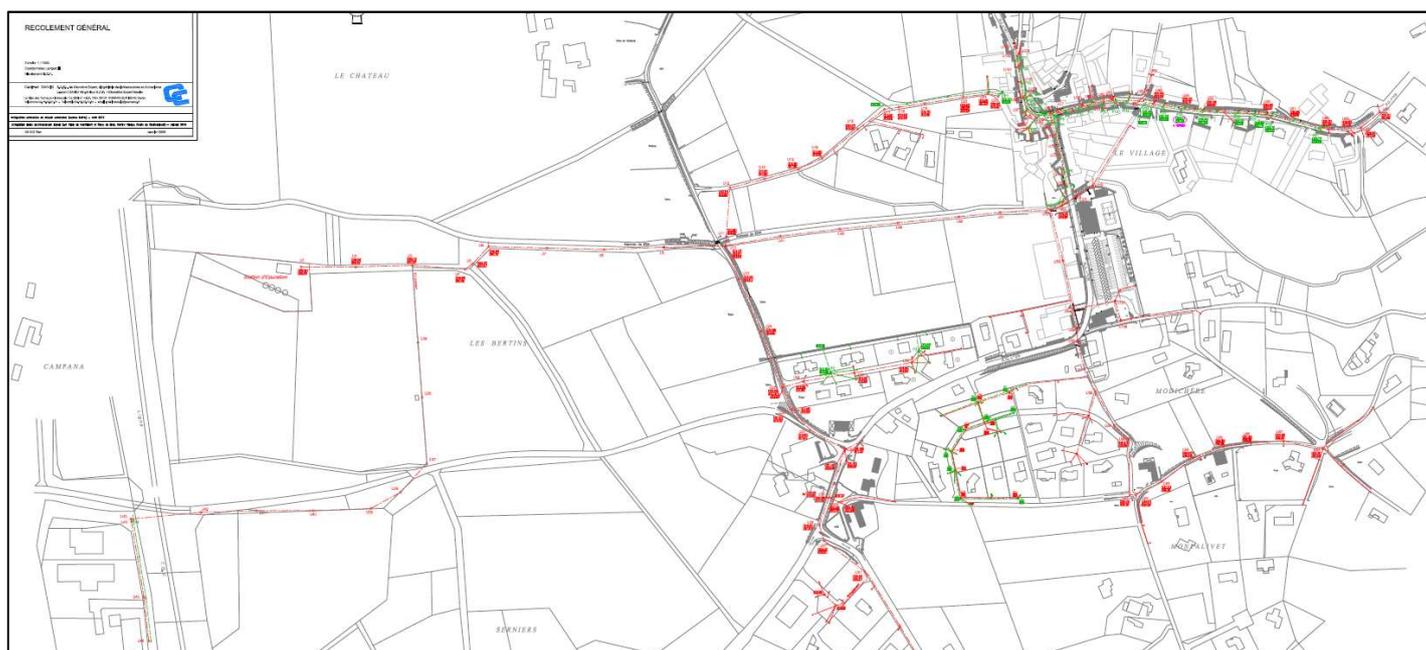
Plan du réseau d'assainissement au niveau du centre bourg (source : Mairie de Claveyson)
